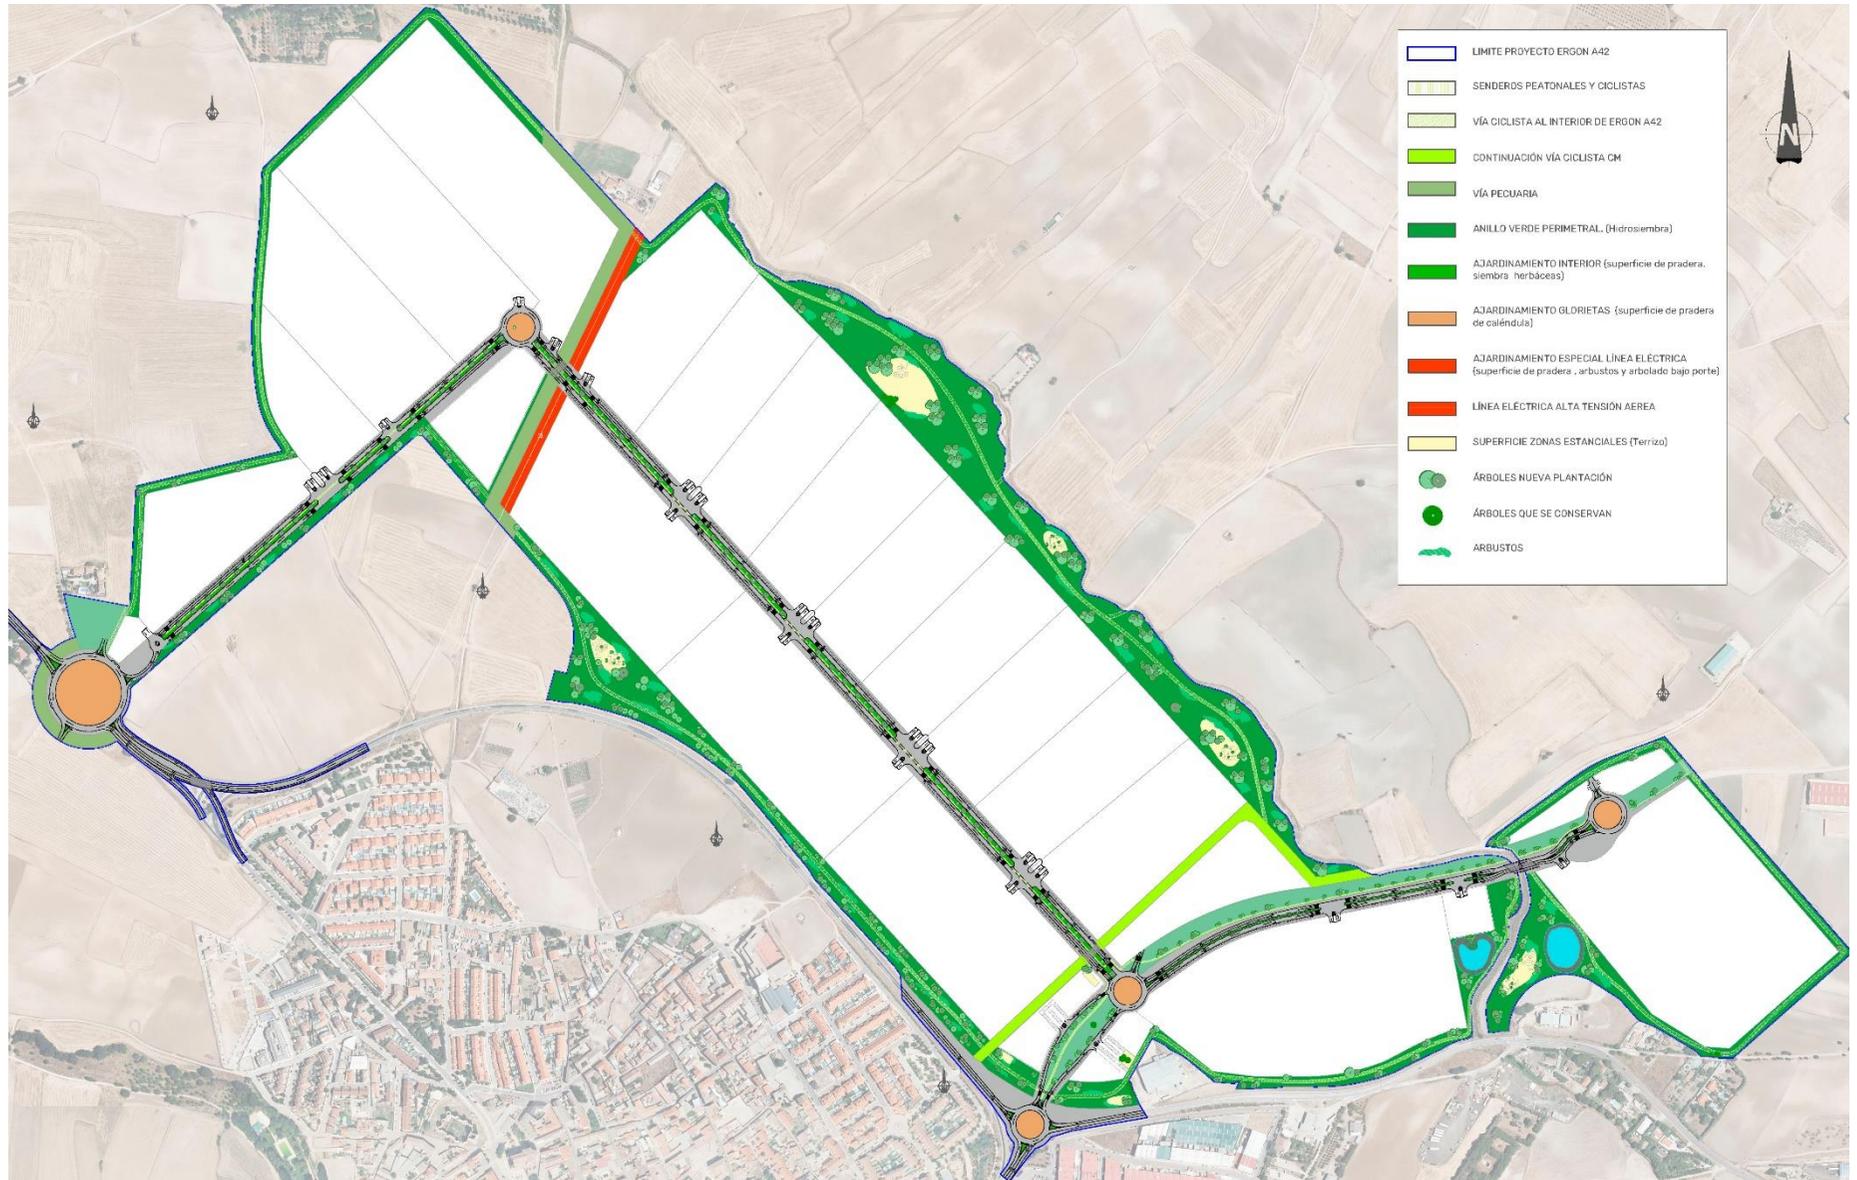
Plano vía pecuaria en su encuentro con la rotonda de acceso. Fuente: Elaboración propia.
